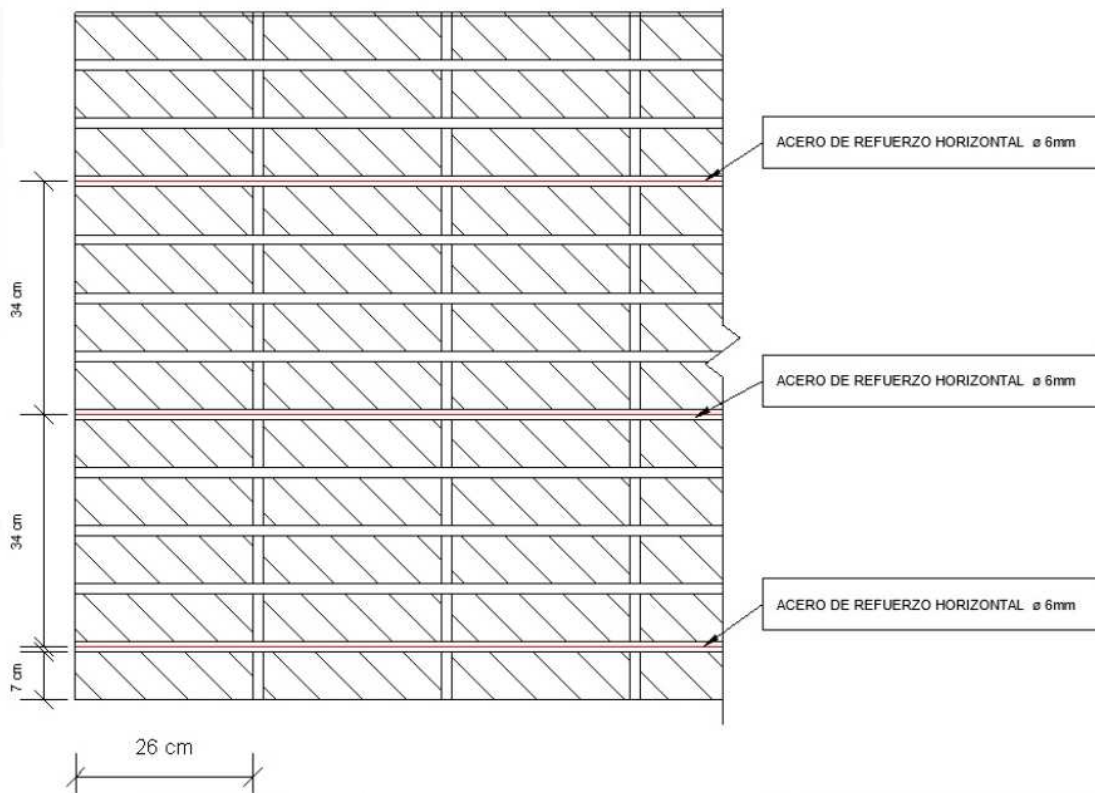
Vista Lateral - Detalle Acero Horizontal del Muro de confinamiento.
